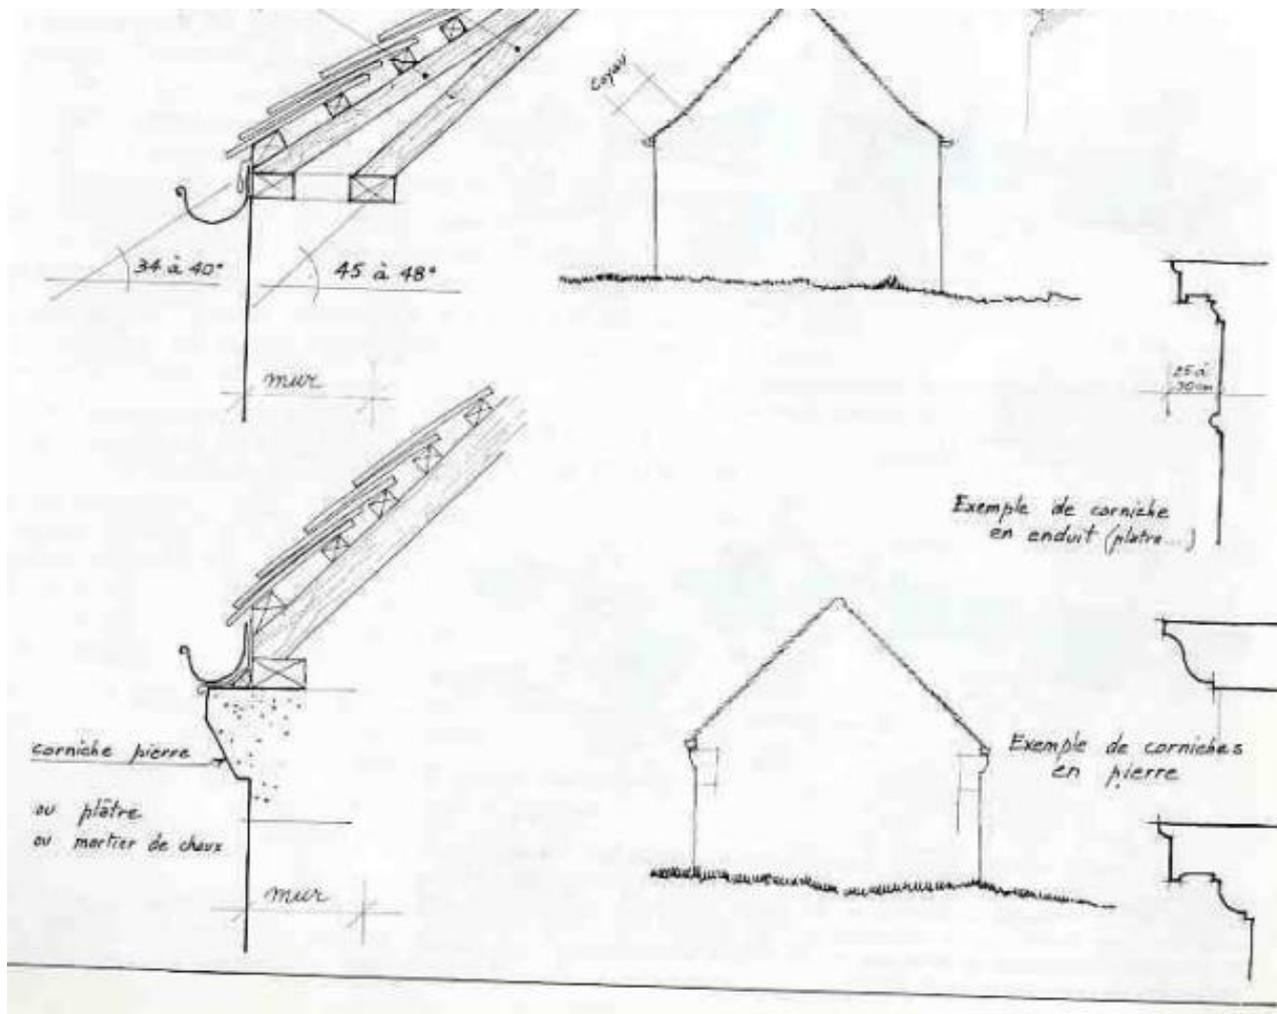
Les corniches soulignent horizontalement les façades (source : CAUE 78)
